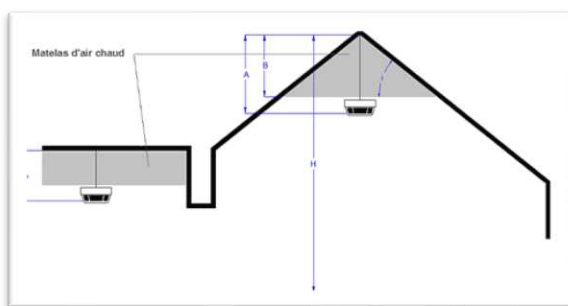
POSITION DU CAPTEUR PAR RAPPORT AU PLAFOND
